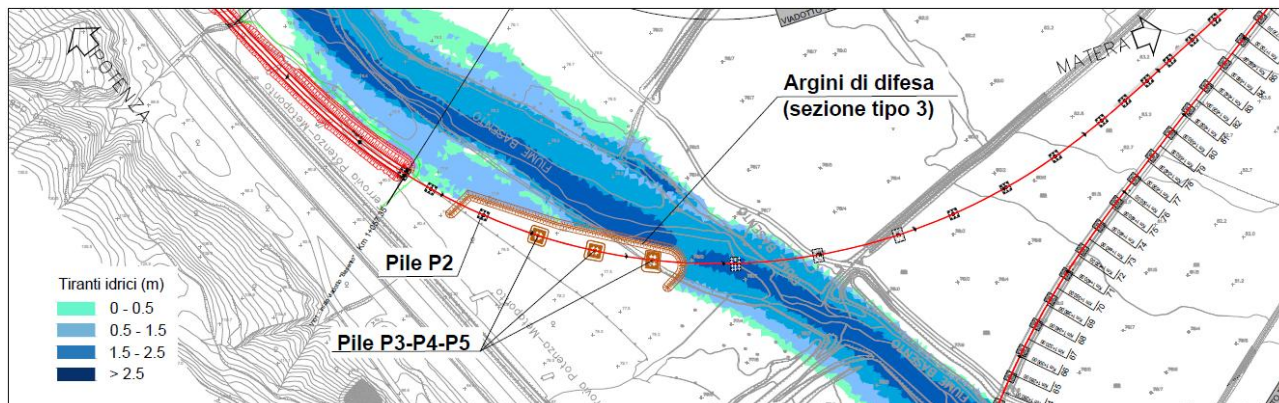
Aree di esondazione nella fase di cantiere 2.
